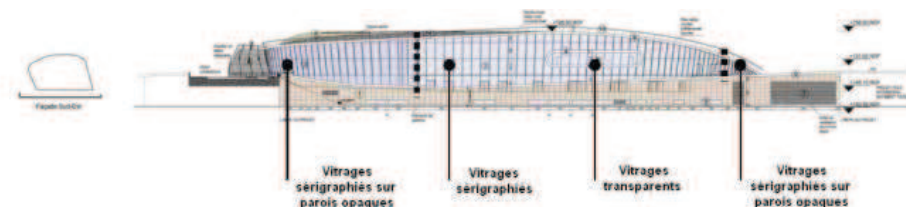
ELEVATION SUD MONTRANT LA REPARTITION DES TROIS TYPES DE FAÇADE RIDEAU
